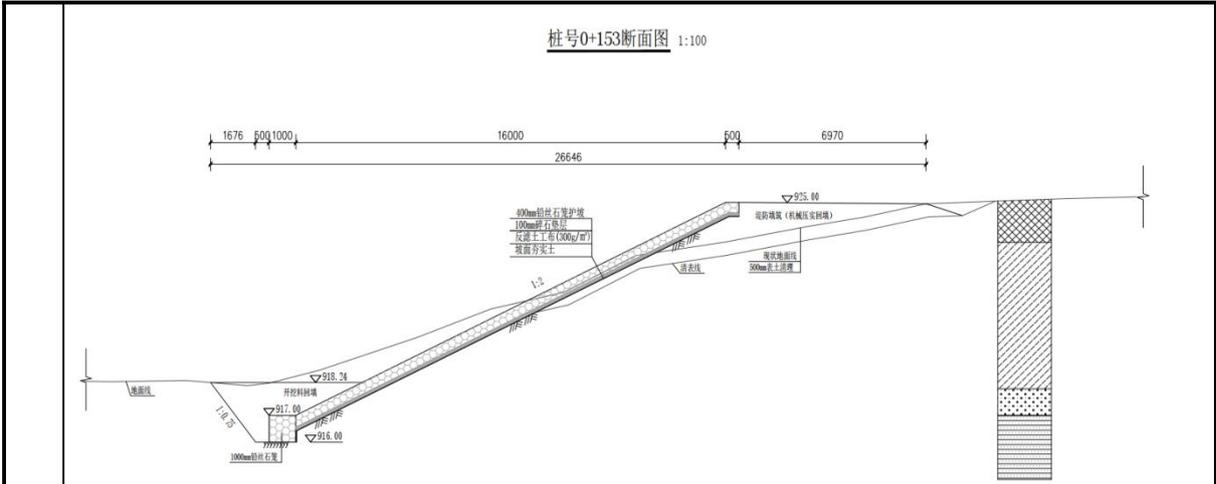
桩号 0+153 断面图 (摘自初设报告)
